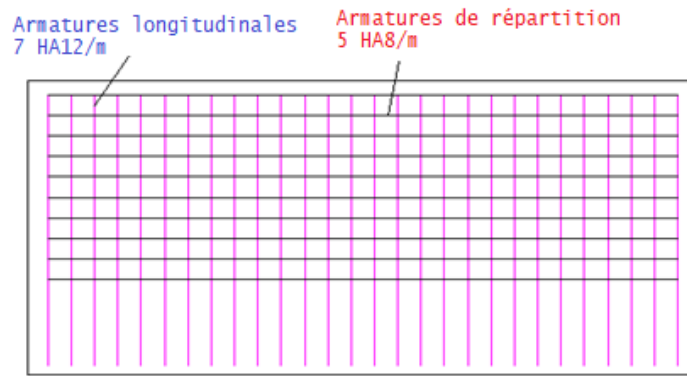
Vue en plan du ferrailage du balcon selon le CBA 93.
